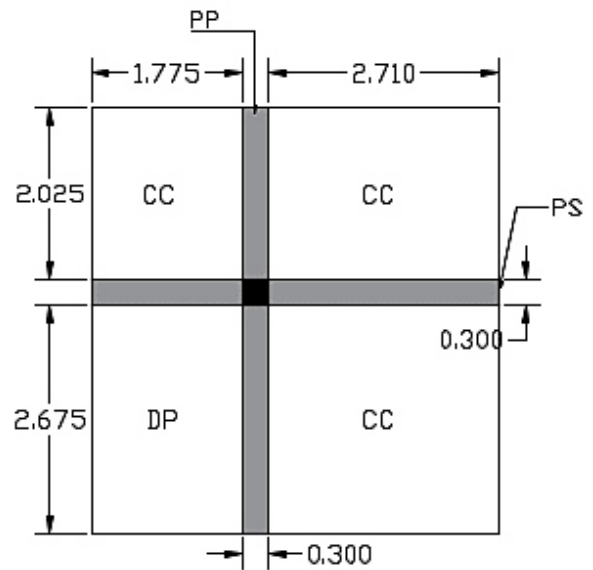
Surface afférente du poteau P2 (RDC+ étages courants).
